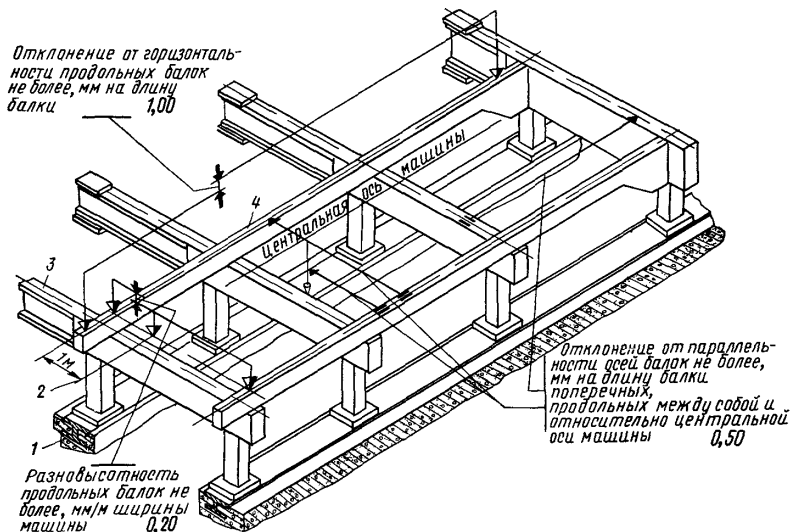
Схема станины с основными контролируемыми монтажно установочными размерами и допуски на монтаж
